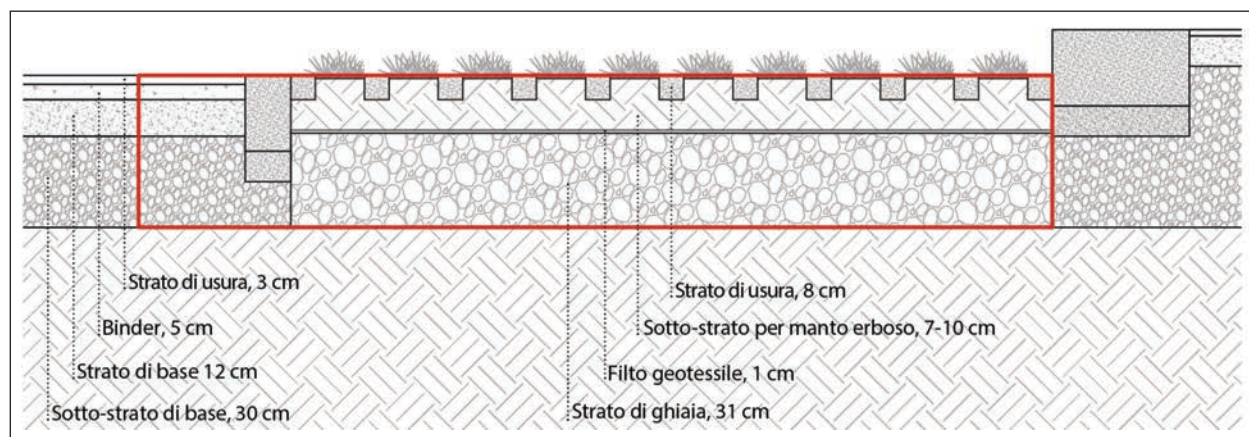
Stratigrafia della pavimentazione drenante (elaborazione da Bono et al., 2020).
